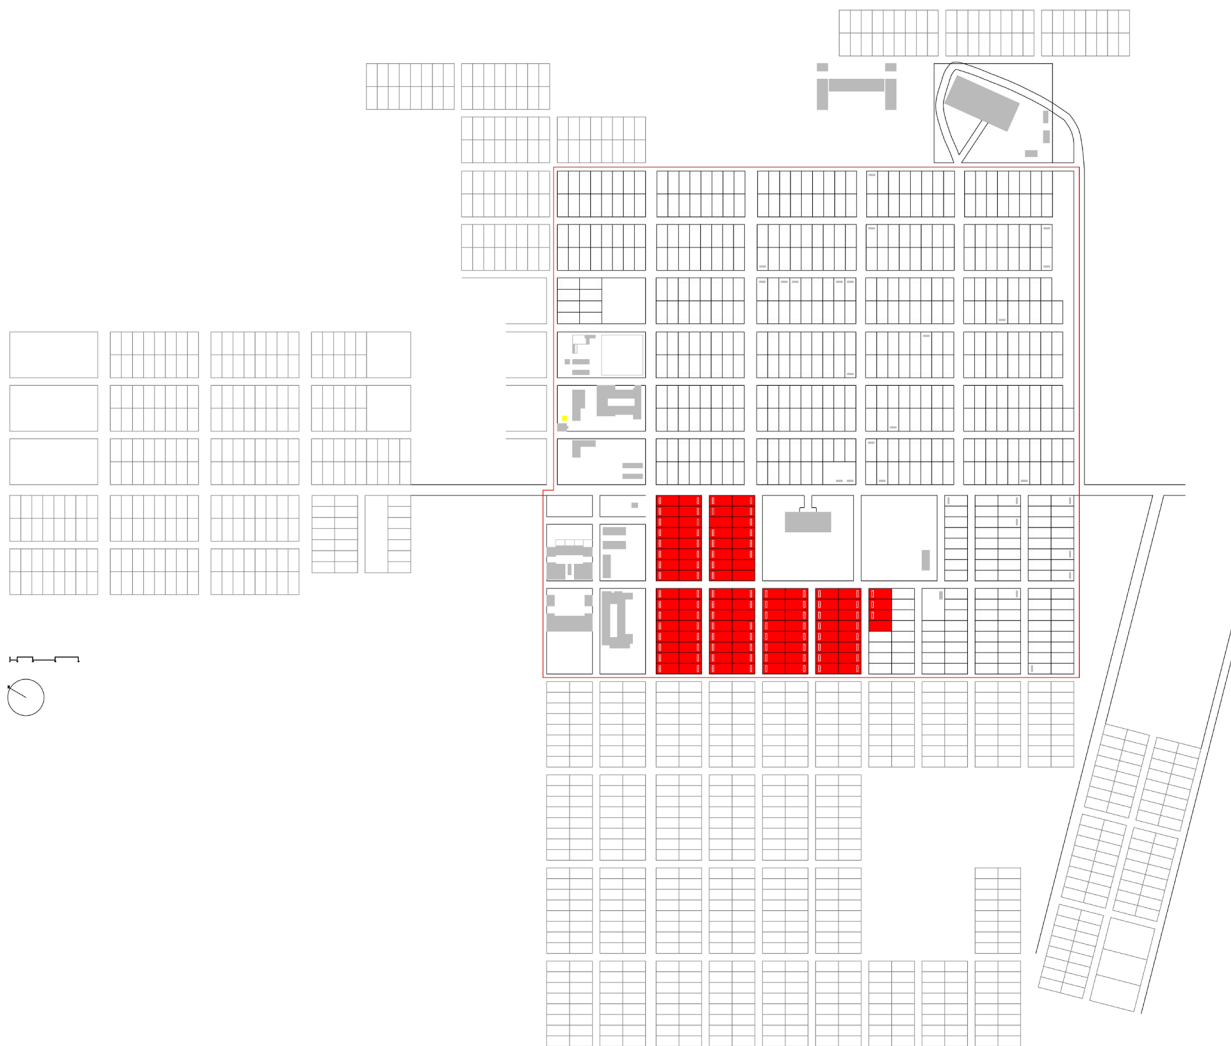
Segunda fase de construção, final de 2003 a 2004.(ver em anexo planta com legendas e outras fases).
